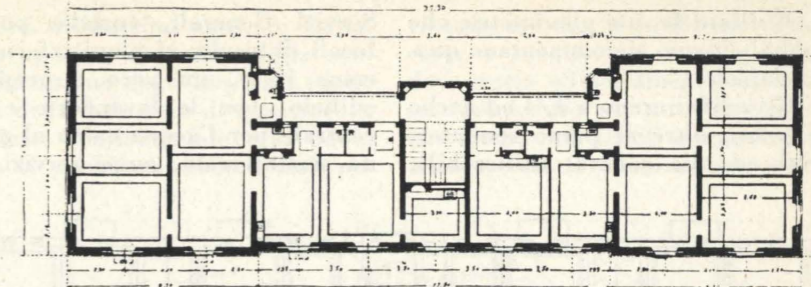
Progetto 1° classificato: pianta - tipo di un edificio con 6 alloggi per piano.
